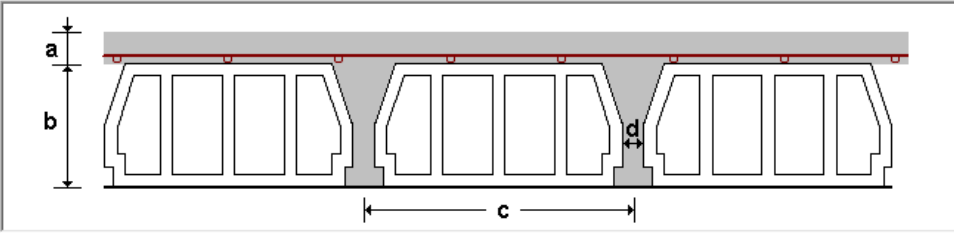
Dimensiones de losa de viguetas pretensadas.
